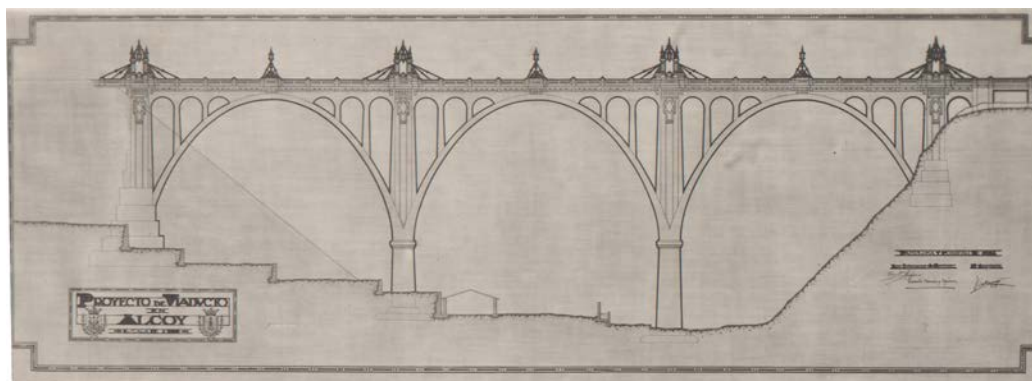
Alzado del proyecto del Puente de San Jorge. Febrero 1924.
